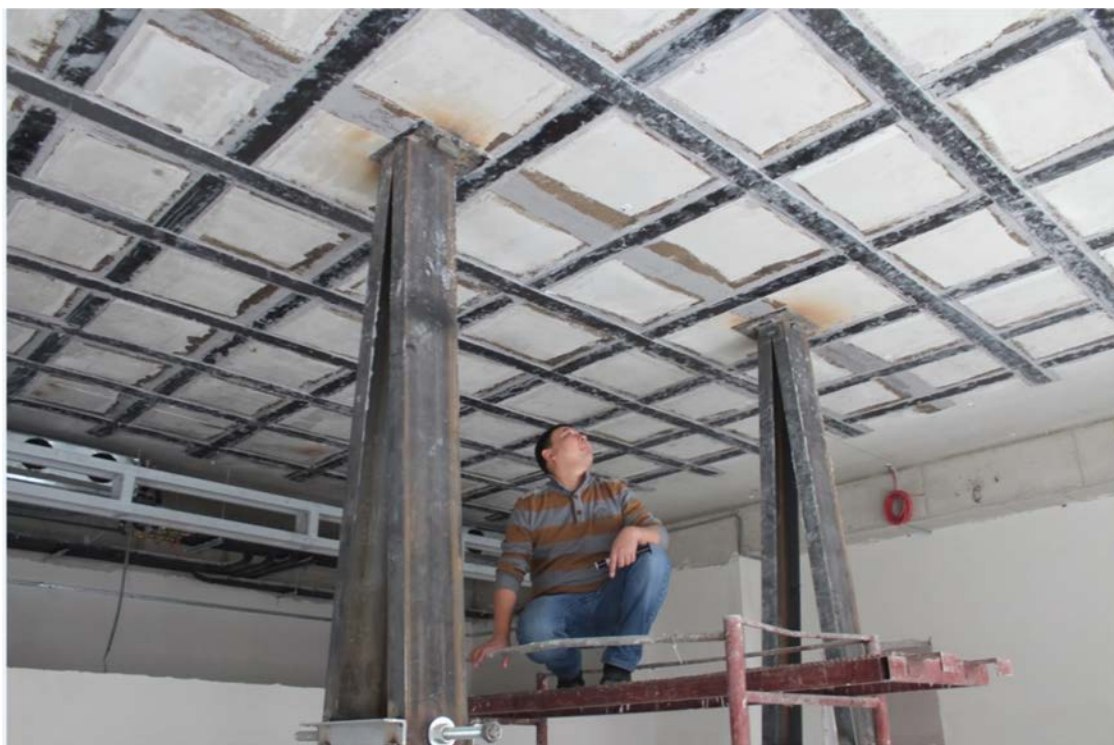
Телескопическая стойка и замеры ширины раскрытия трещин в железобетонной плите перекрытия Блока «С»
